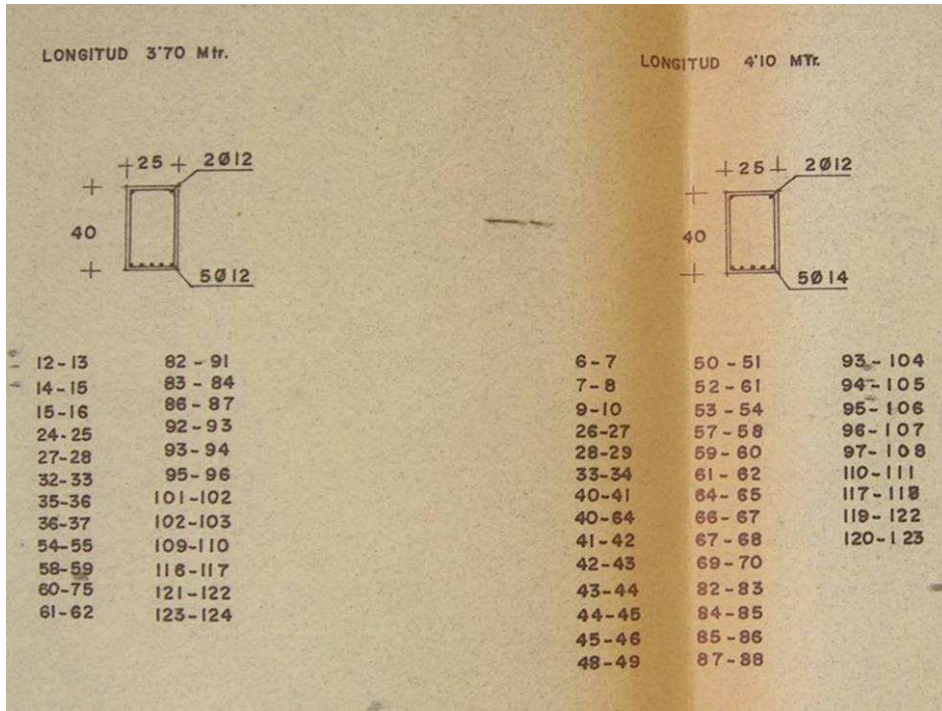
Armado y geometría de vigas. Edificio 88C.019, 1966
